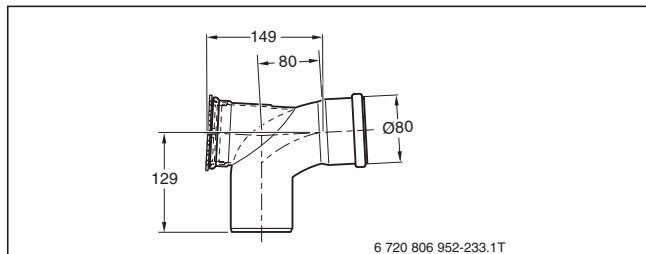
Bogen mit Prüfföffnung lang (Maße in mm)
